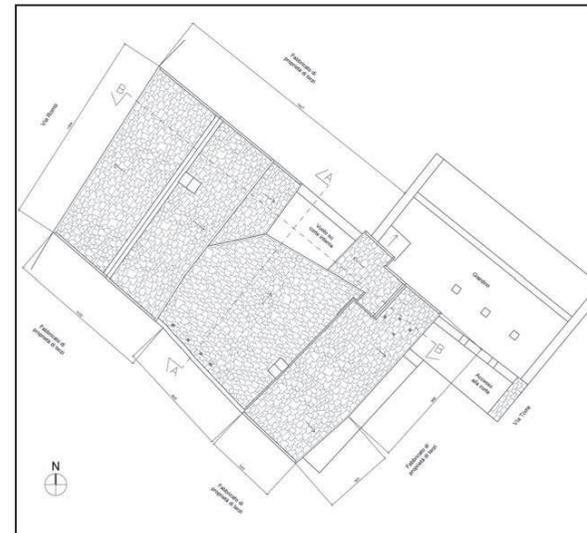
Planimetria generale - Fonte: Elaborazione ERSAP; ENERGE Srl
